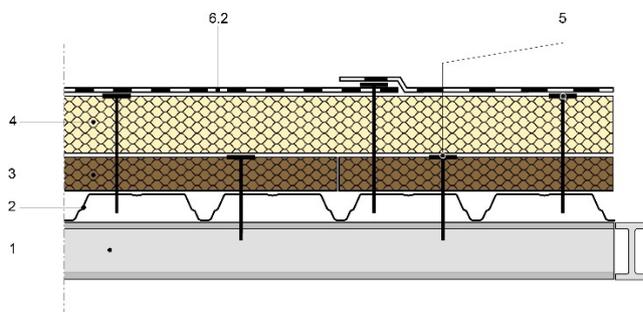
c : Coupe de principe du procédé avec une étanchéité fixée mécaniquement et un écran thermique sur TAN
